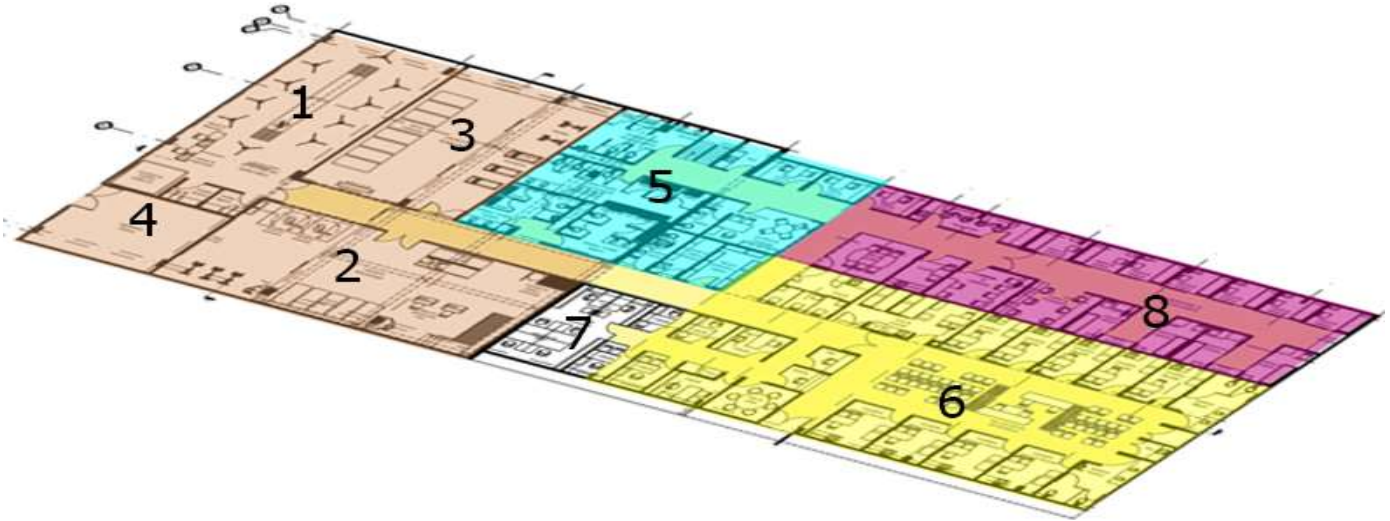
Planta Arquitectónica PROYECTO CENTRO DE FISIOTERAPIA HG. (2019)
